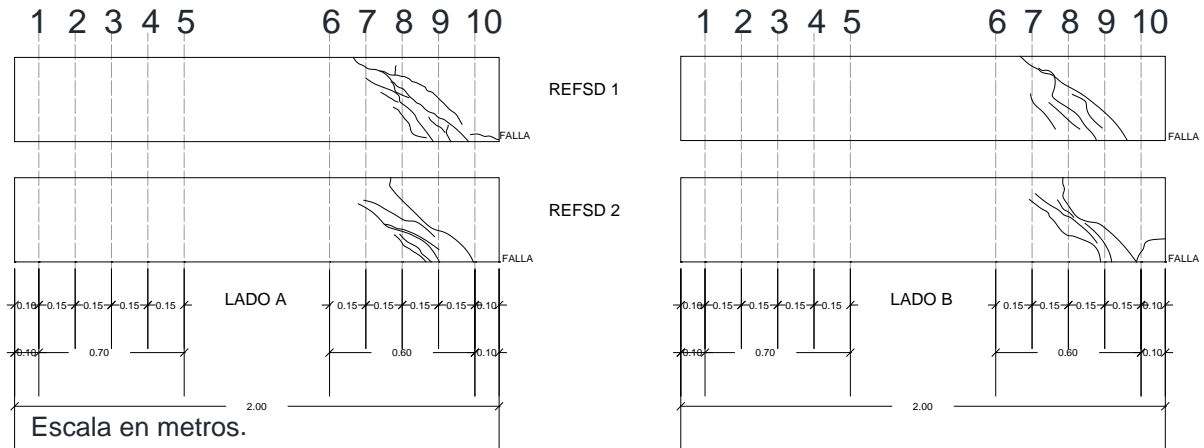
Patrón de agrietamiento en ambas caras de las vigas de control sin deterioro ensayadas a flexión.
